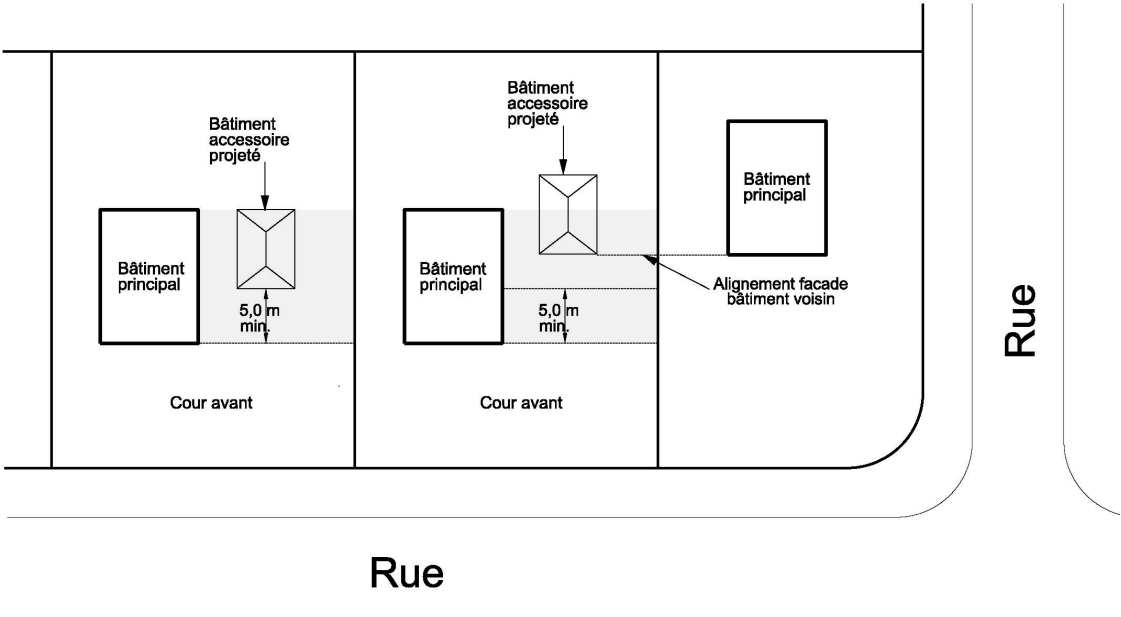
Bâtiment accessoire en cour latérale sur rue
